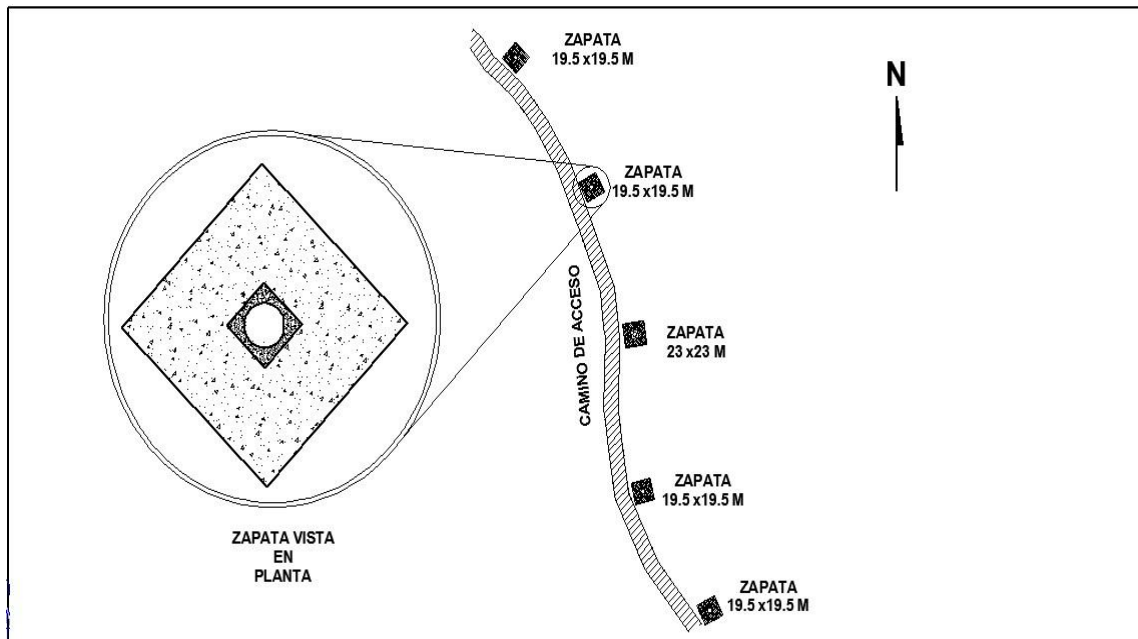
Localización de zapatas de cimentación dentro de la planta eólica “La Rumorosa I”.
